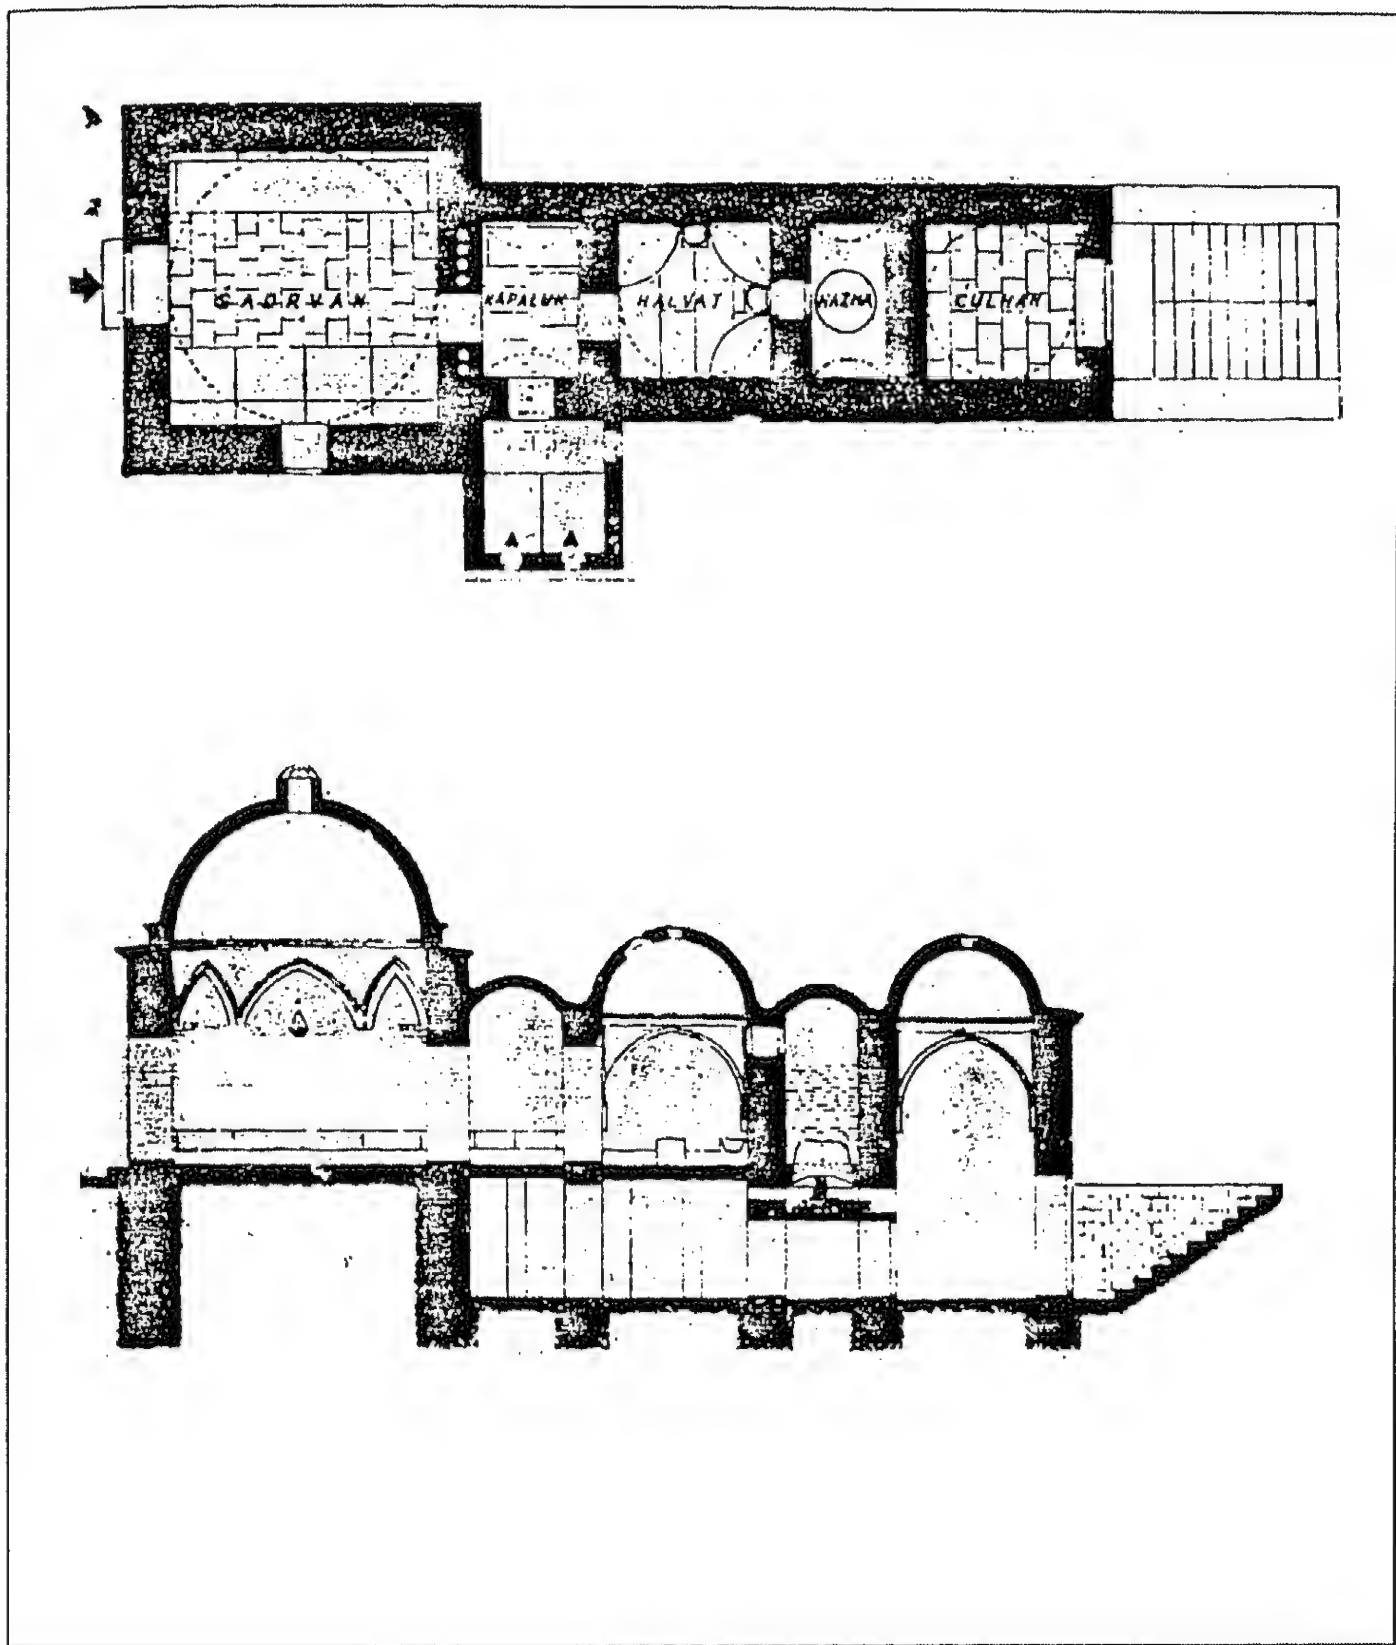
مسقط أفقي وقطاع حمام غازي خسرو بك في سرايفو (عن: Pašić).
